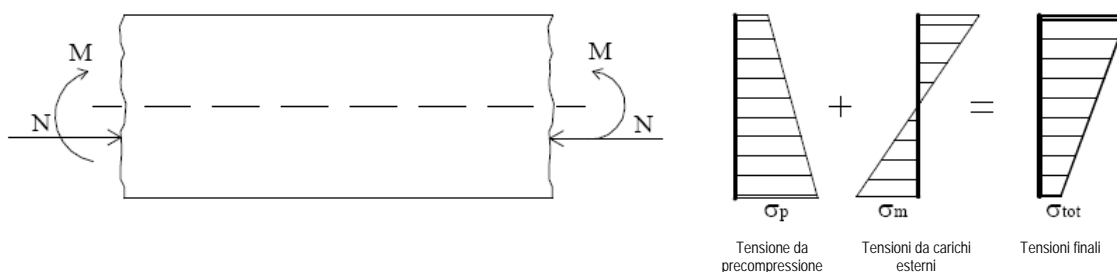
Effetto di sovrapposizione delle tensioni in una trave in c.a.p.
